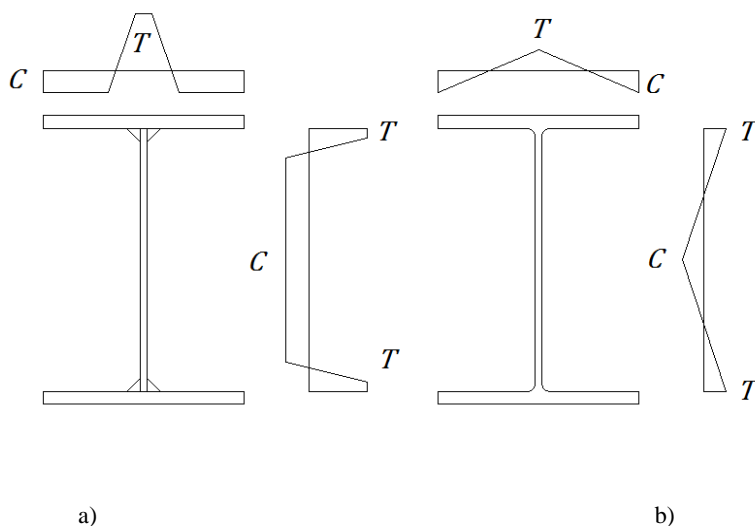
Tensões residuais em a) perfis soldados; b) perfis laminados.
